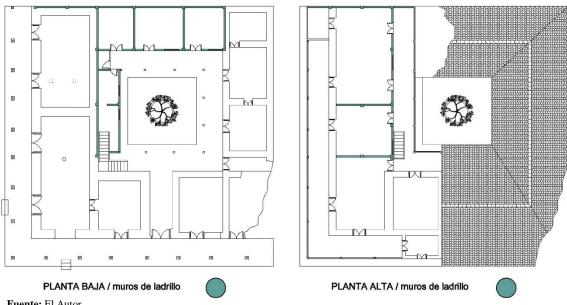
Hormigón armado con mampostería de ladrillo como elemento constructivo de la vivienda familia Carrión
